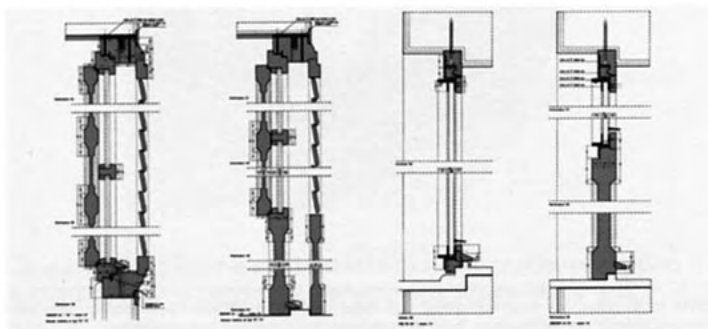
Fabrizio Avella, sezioni verticali per il progetto di restauro del Museo etnografico Giuseppe Pitre di Palermo (progettista: Giuseppe Pagnano). Il piano di sezione è verticale e parallelo al quadro di rappresentazione.
